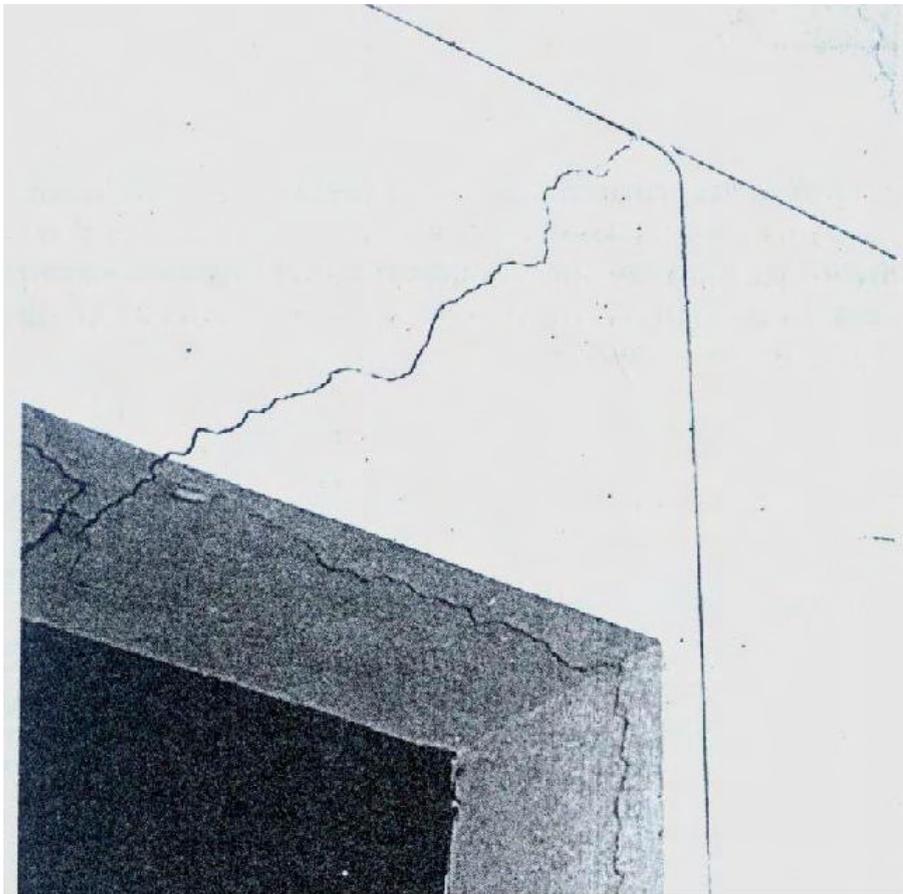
Viga fissurada por torção. FONTE: CÁNOVAS (1994).
